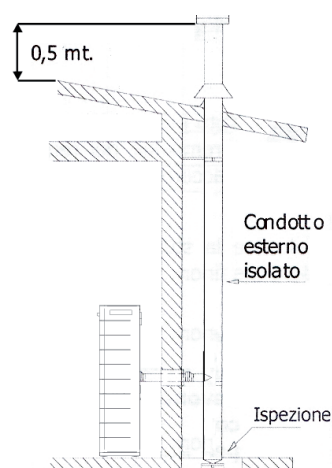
collegamento ad un condotto esterno con tubo isolato o doppia parete
